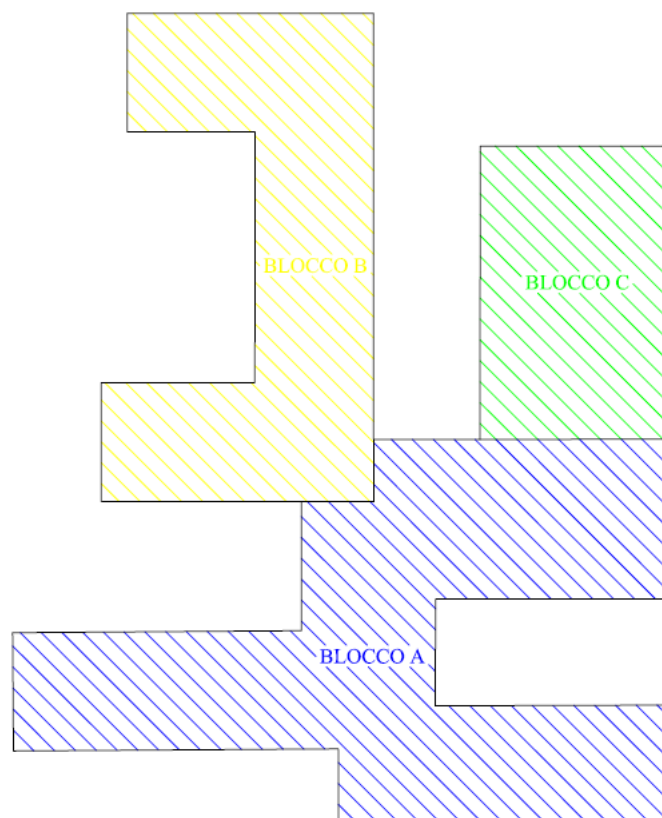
Pianta con l'individuazione dei giunti strutturali
